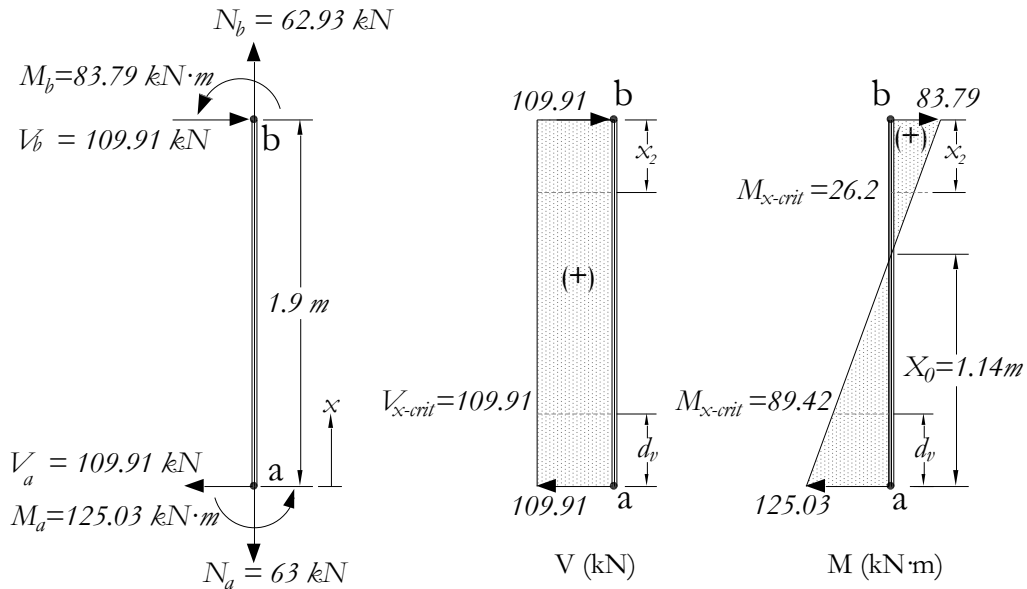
Diagrama de fuerzas en columna C1 del pórtico P2
